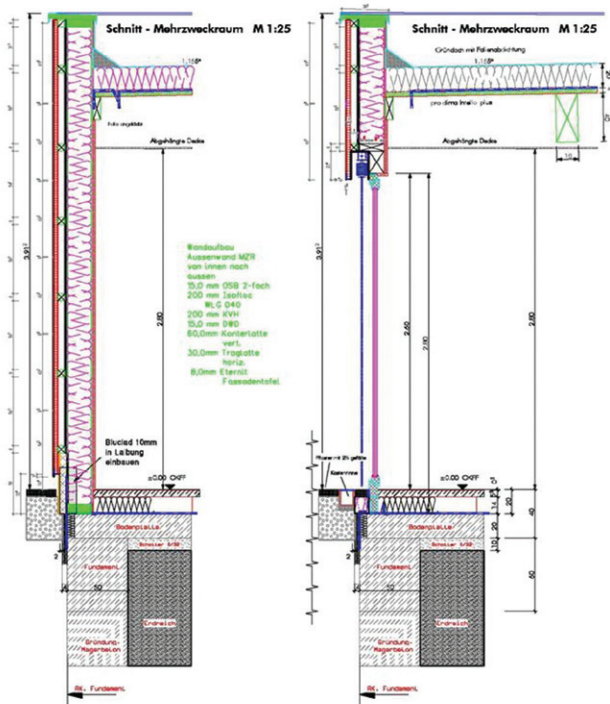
Detalle de la fachada. Cortesía del despacho Möller, Bad Nauheim.
